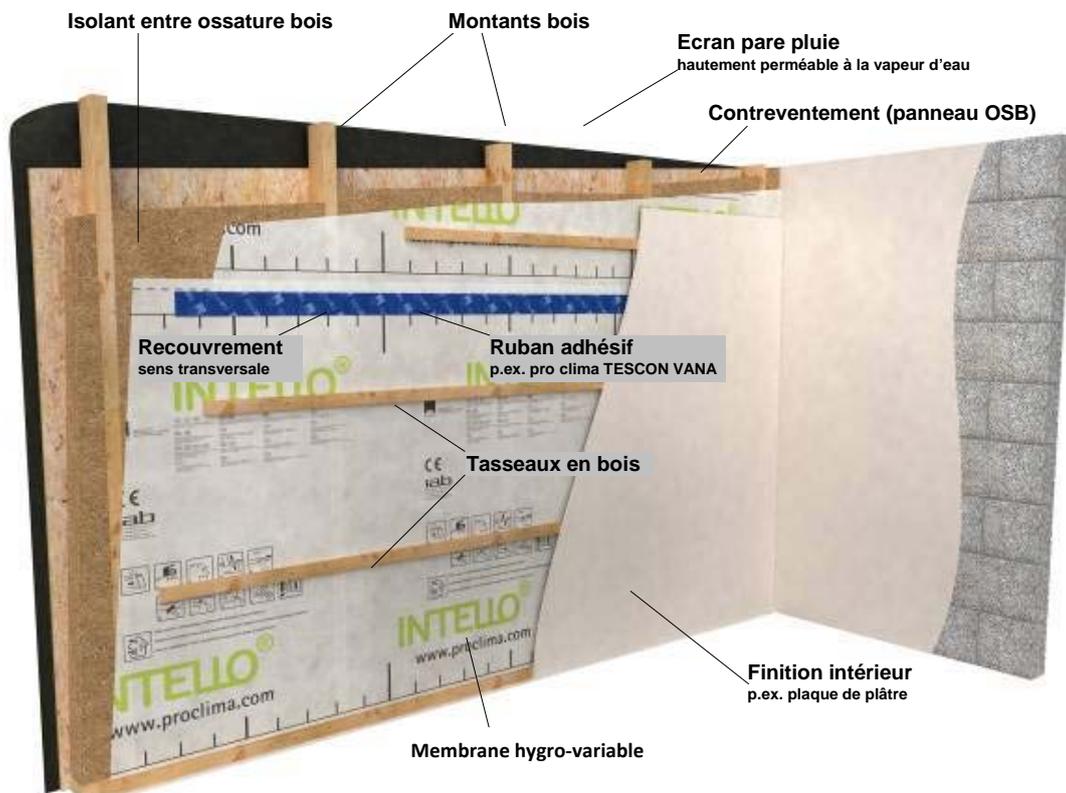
Montage du revêtement intérieur en cas de lattage d'installation
